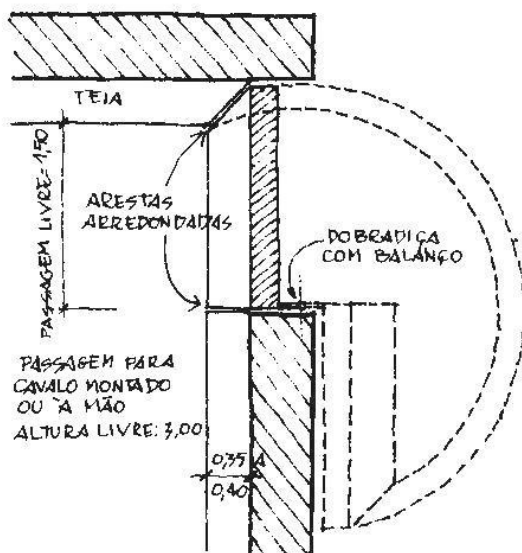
Exemplo – porta secundária do picadeiro (Planta)
